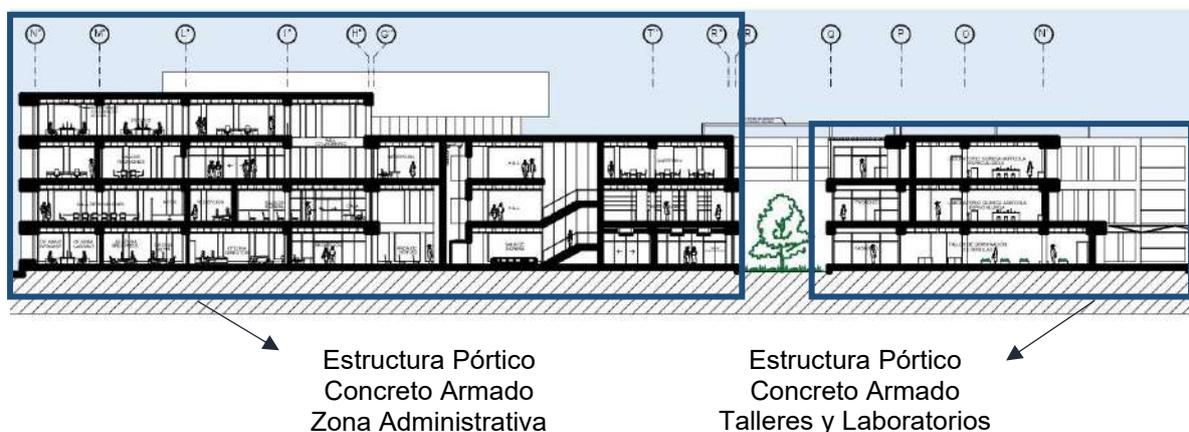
Estructura Zona Administración, talleres y laboratorios
